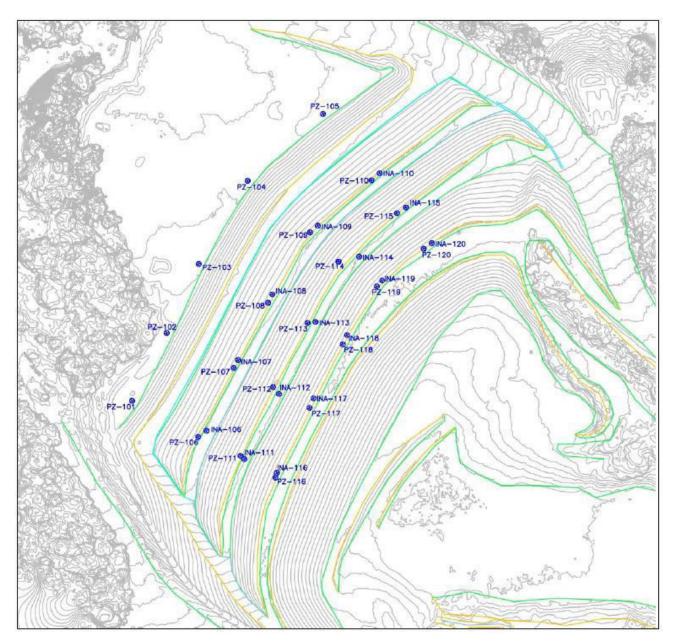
Vista geral da instrumentação instalada na Barragem B1.
